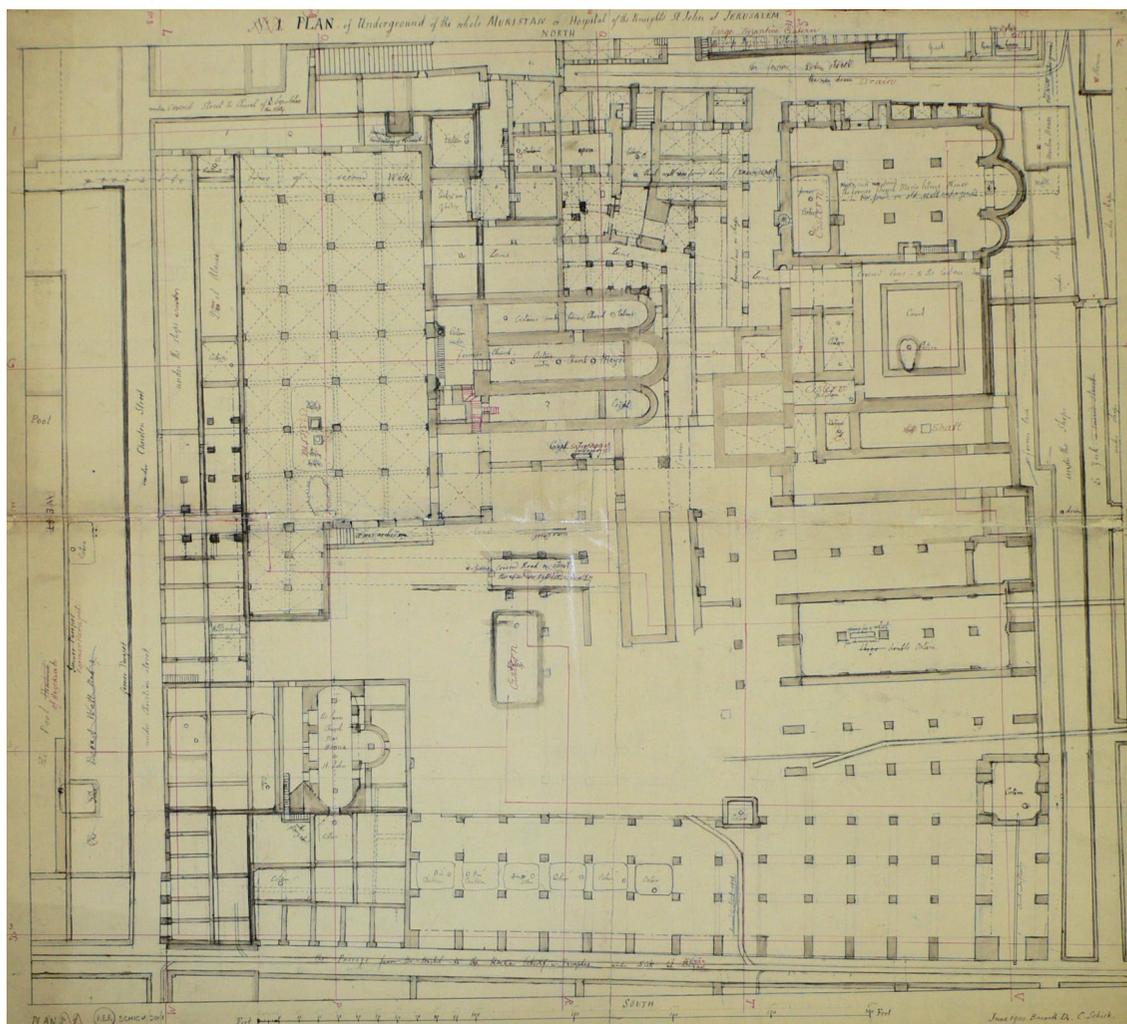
Jerusalem. Muristan, Grundriss der unteren Geschossebene (C. Schick 1900).
